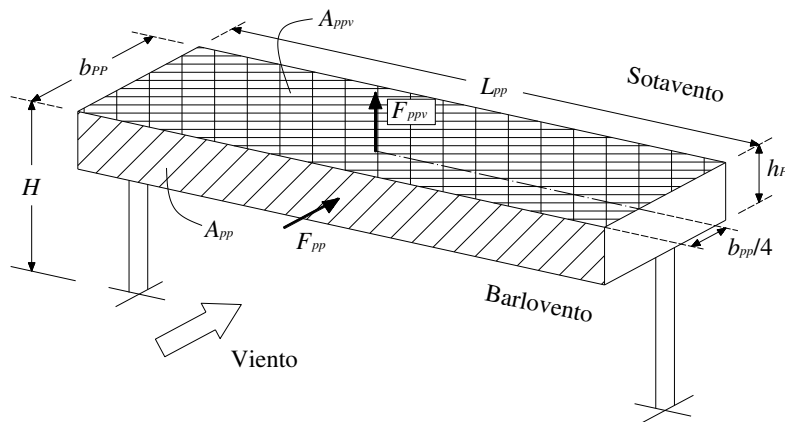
Aplicación de las fuerzas sobre la superestructura
